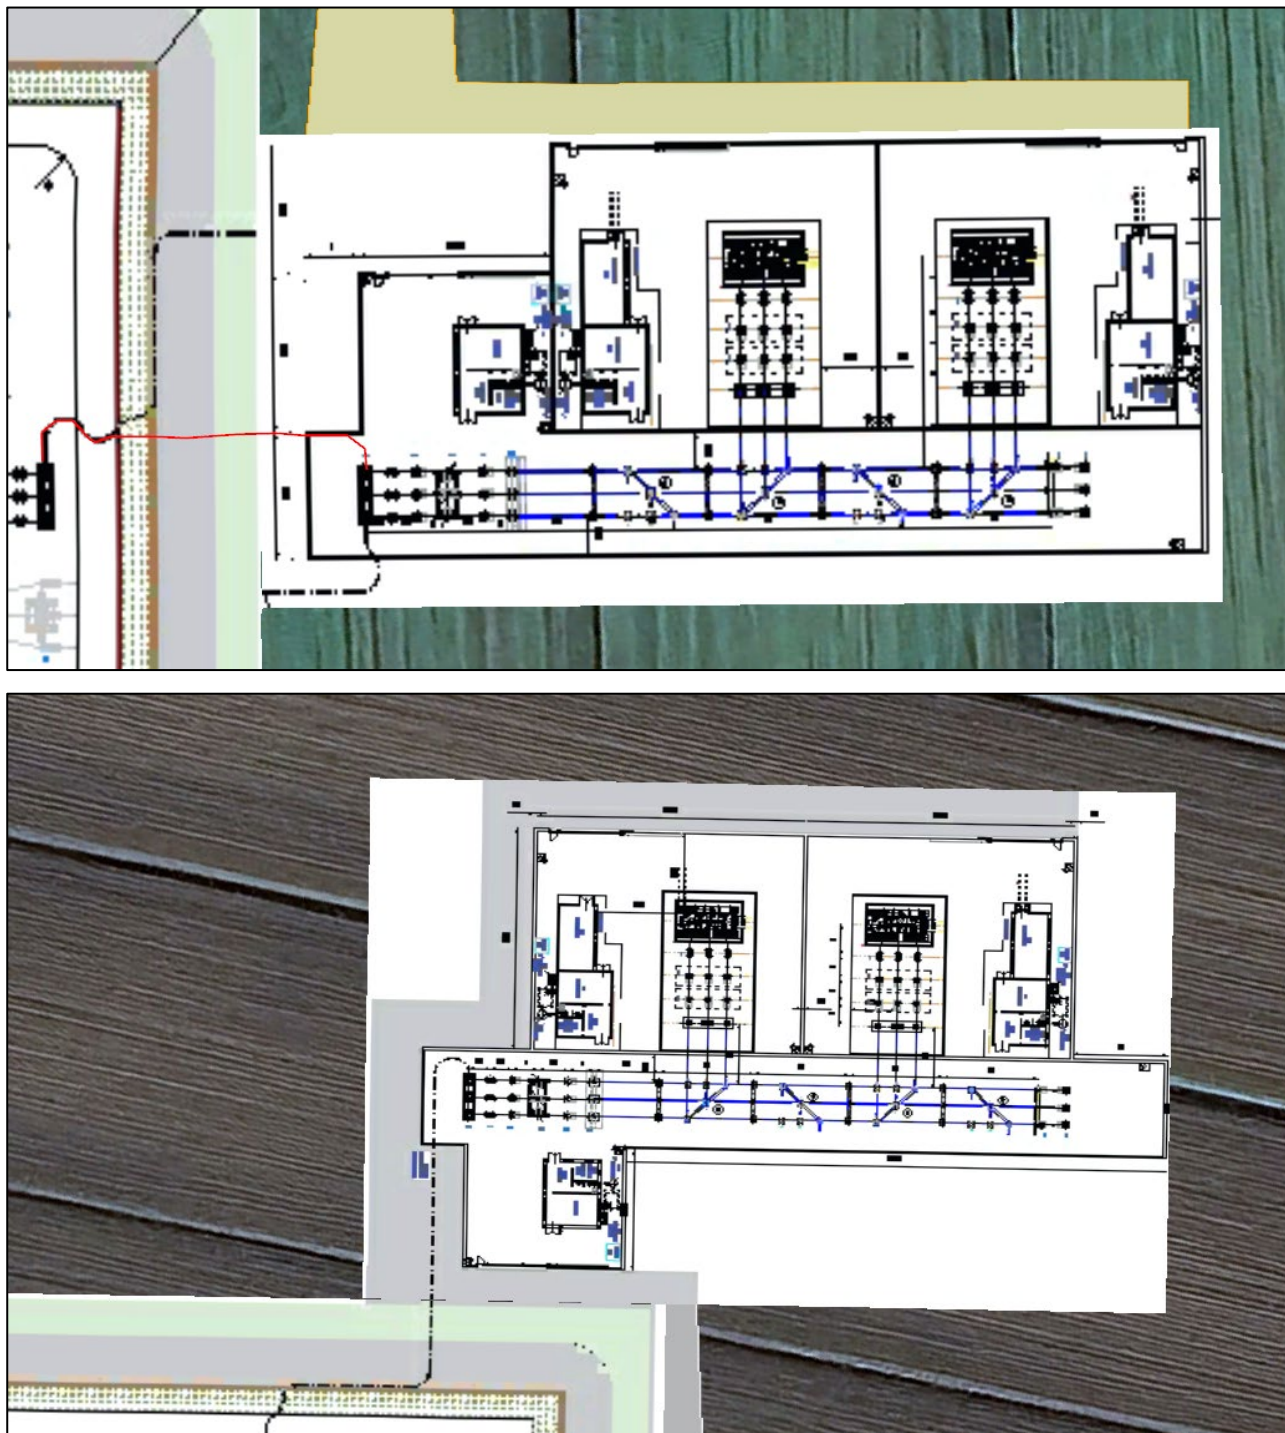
Planimetria S.E.U. Ipotesi 1 e Ipotesi 2
